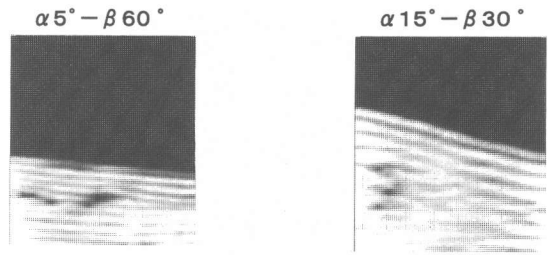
ひび割れの平面形状(黒色部)の表示例
